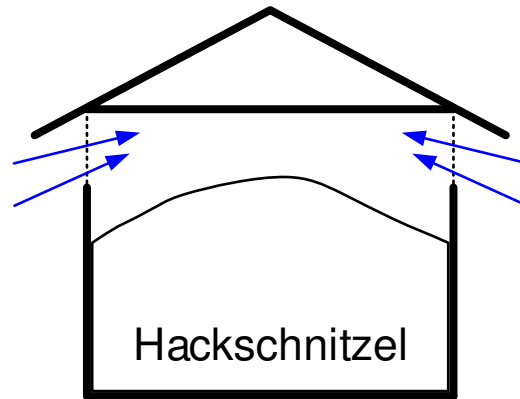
Prinzipskizze einer Lagerhalle mit seitlichen Öffnungen für eine ausreichende Belüftung
